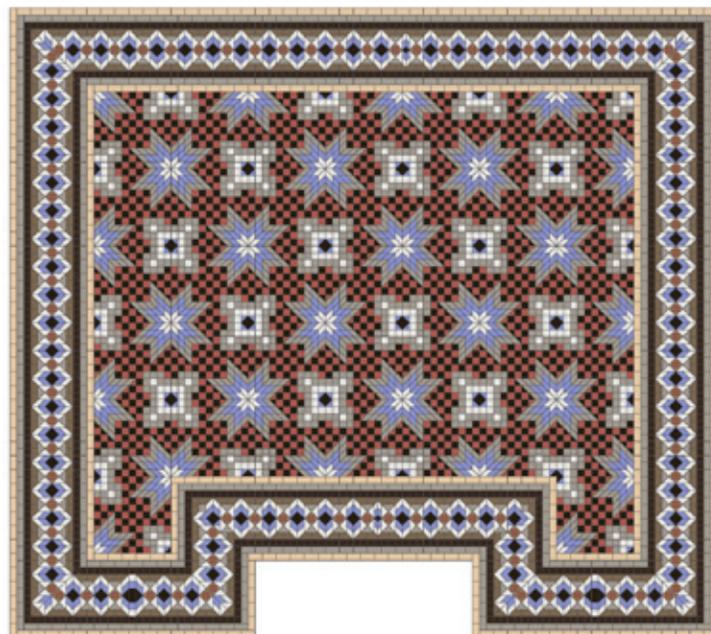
Restitución del pavimento del comedor de invierno en la planta baja. El hueco es para la chimenea (ver figura 3)
